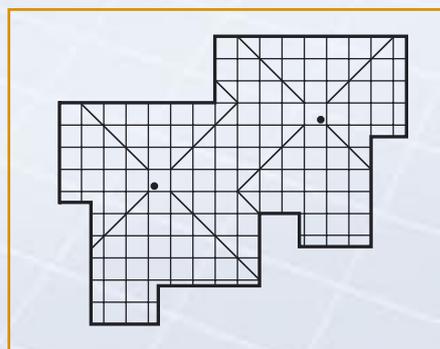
Plan de découpe pour toits en pente en Neopor®.
